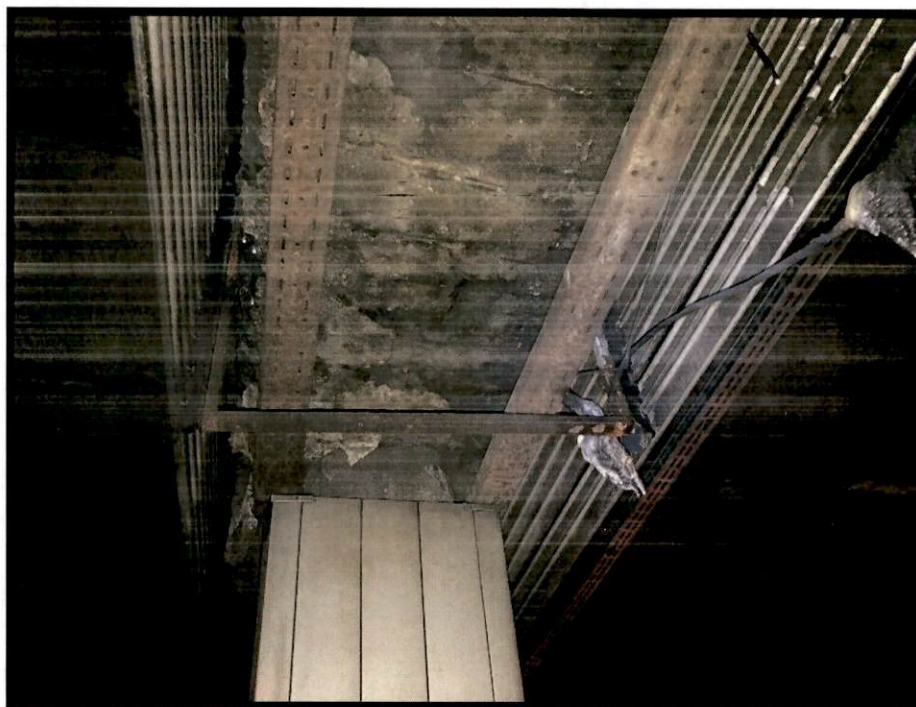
Beton cu aspect friabil și zone din beton exfoliat
